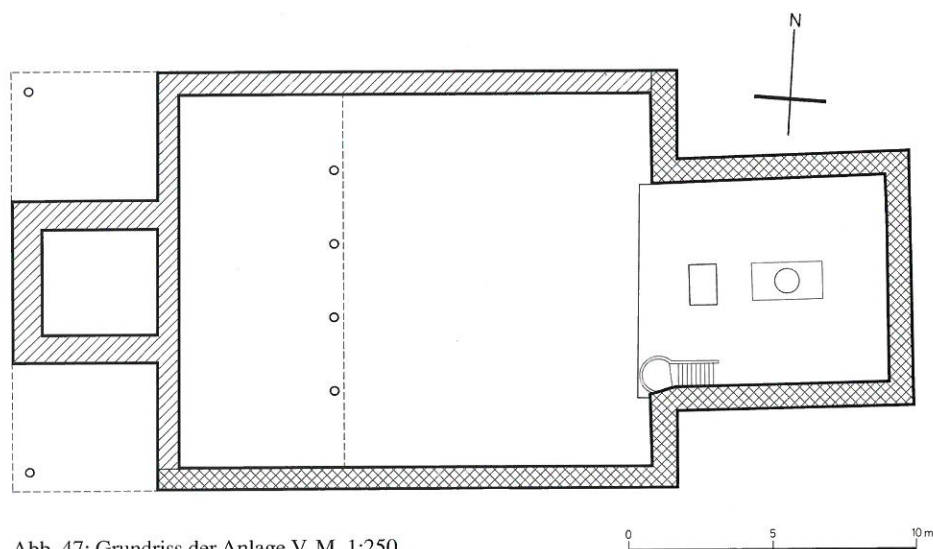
Grundriss der Anlage V. M. 1:250.
